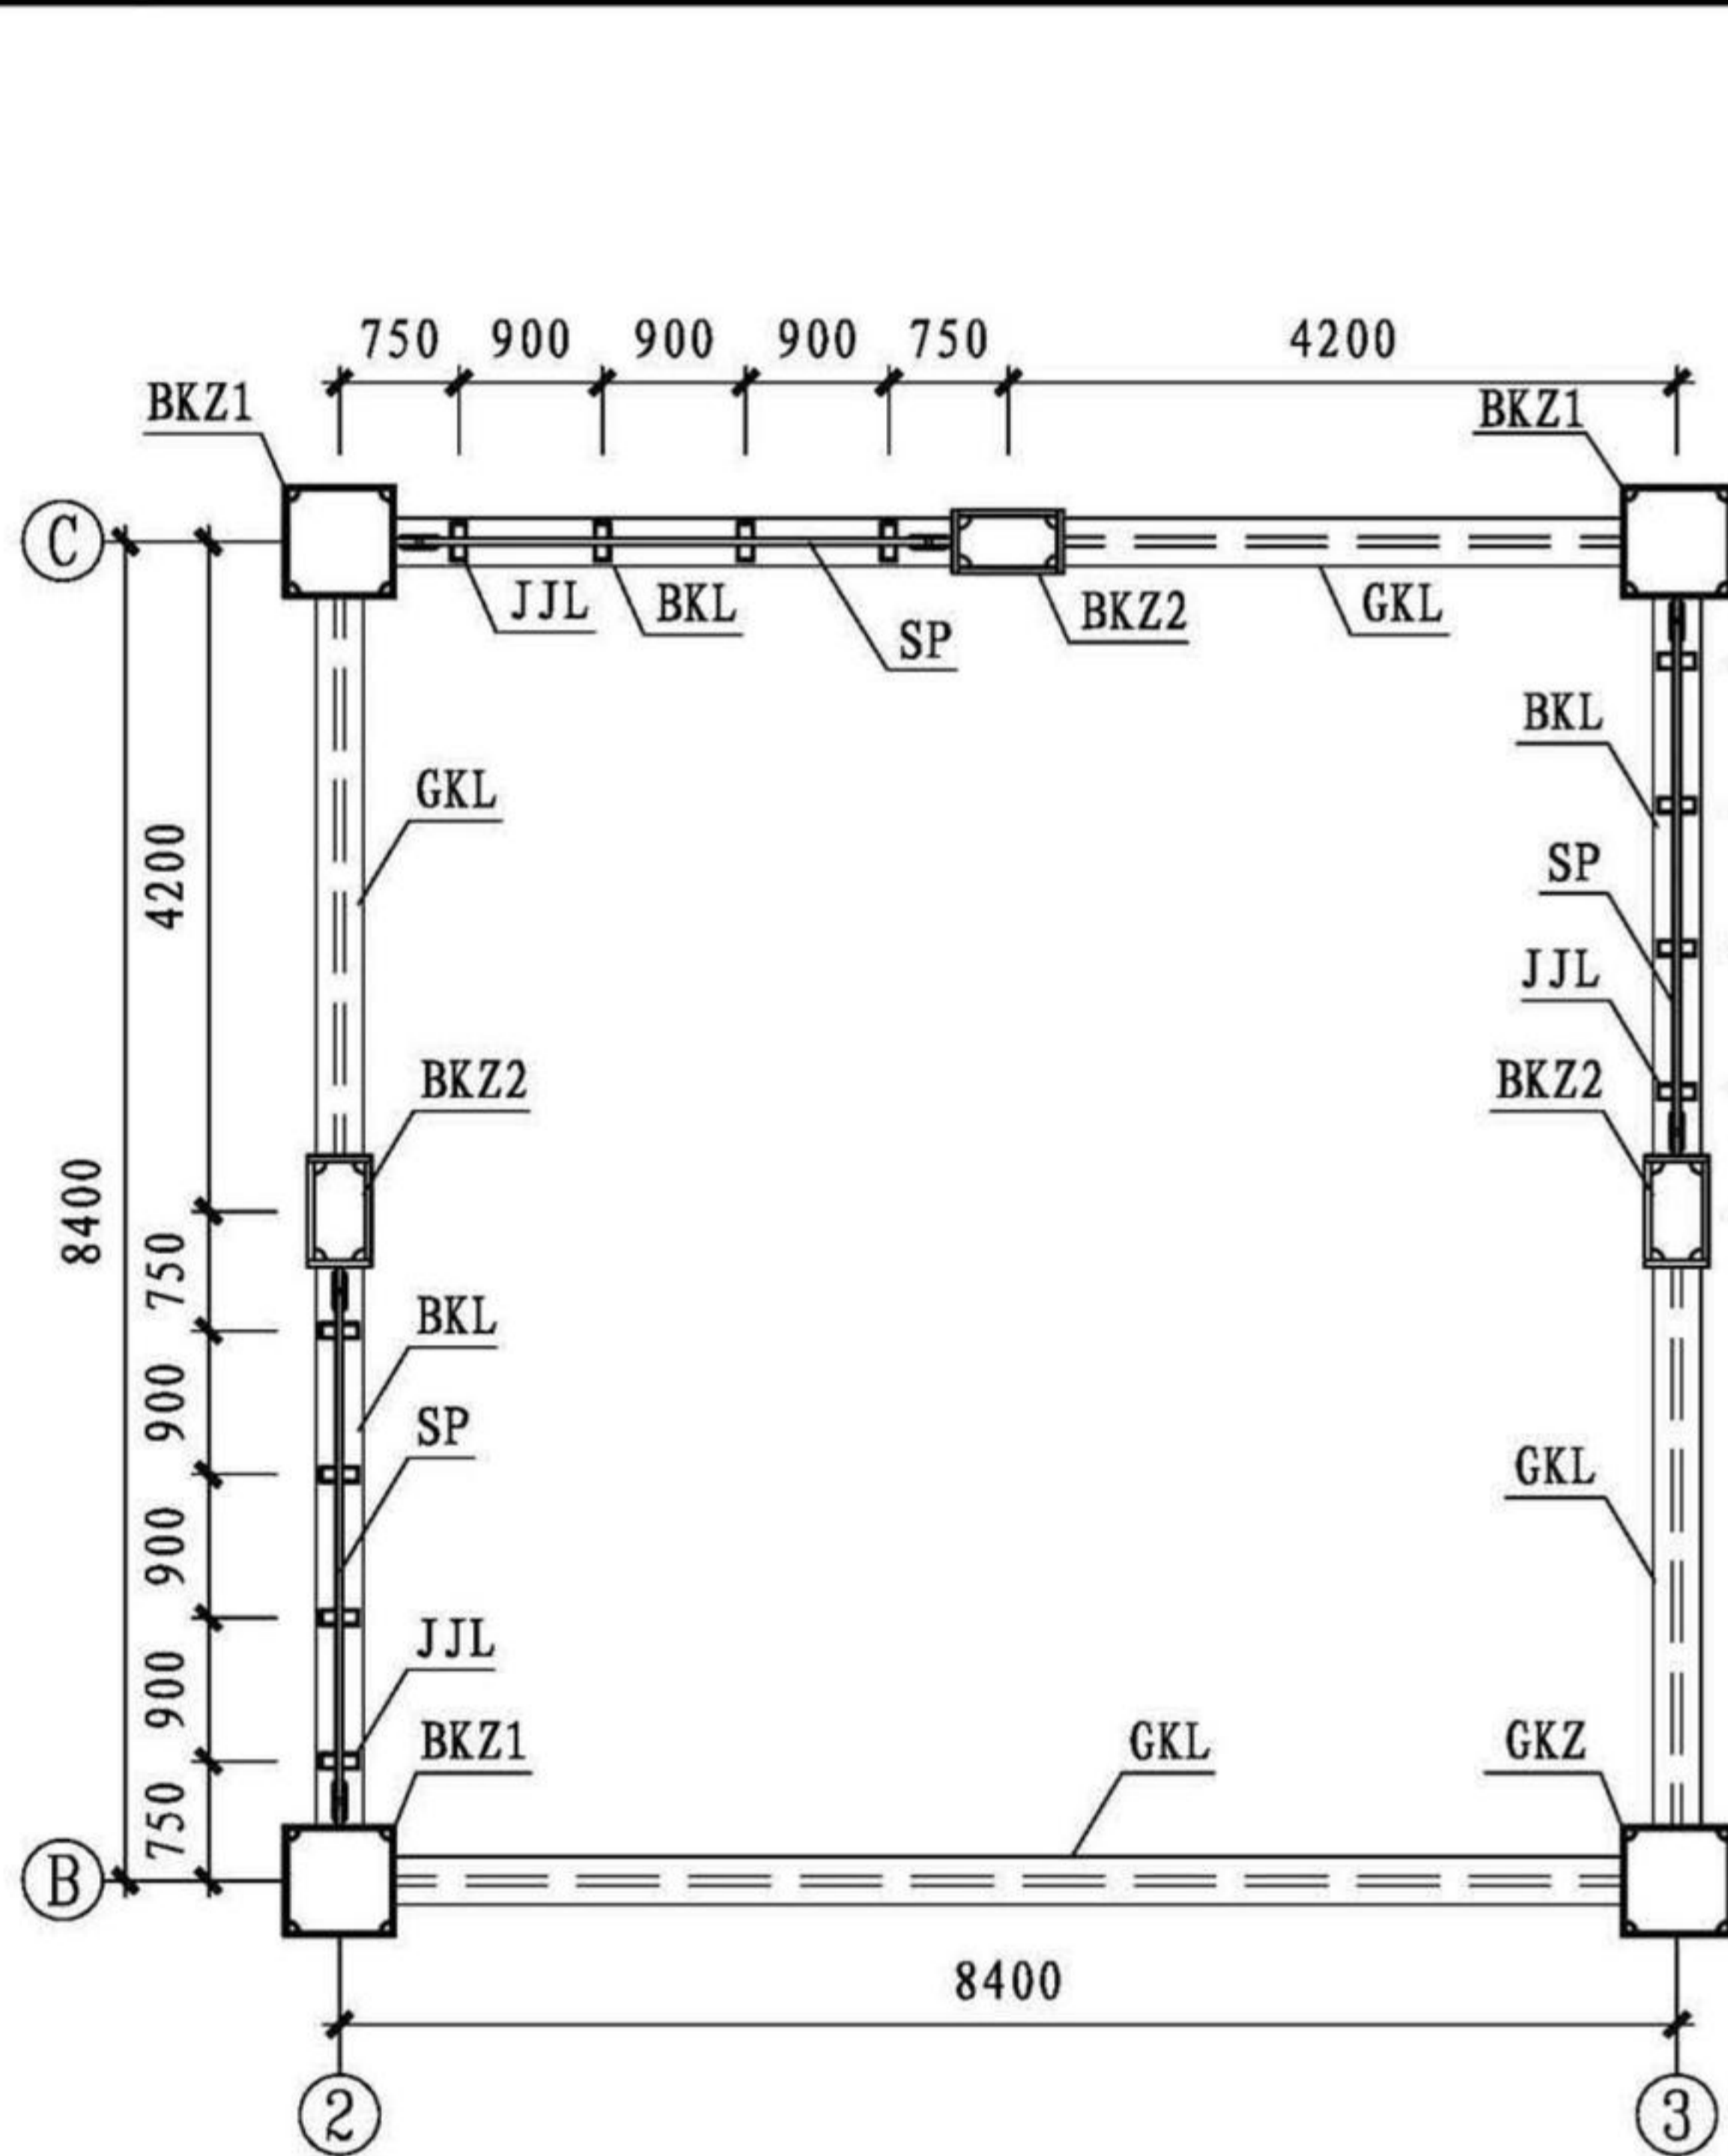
②~③轴×①~②轴钢板剪力墙平面布置图
